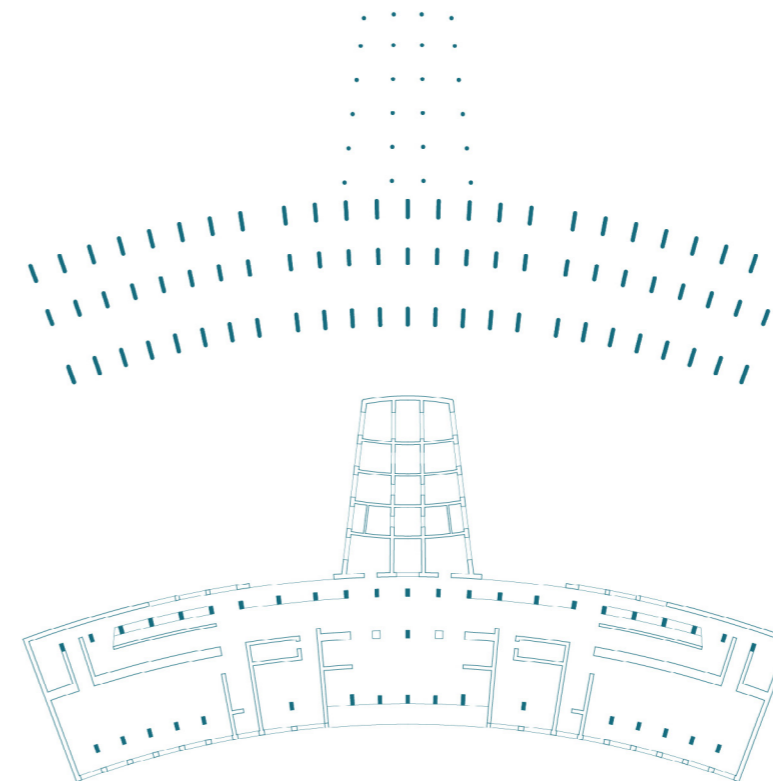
Elaborato grafico raffigurante la pianta del piano pilotis; secondo progetto del 1938 (© Gaia Siddu)
